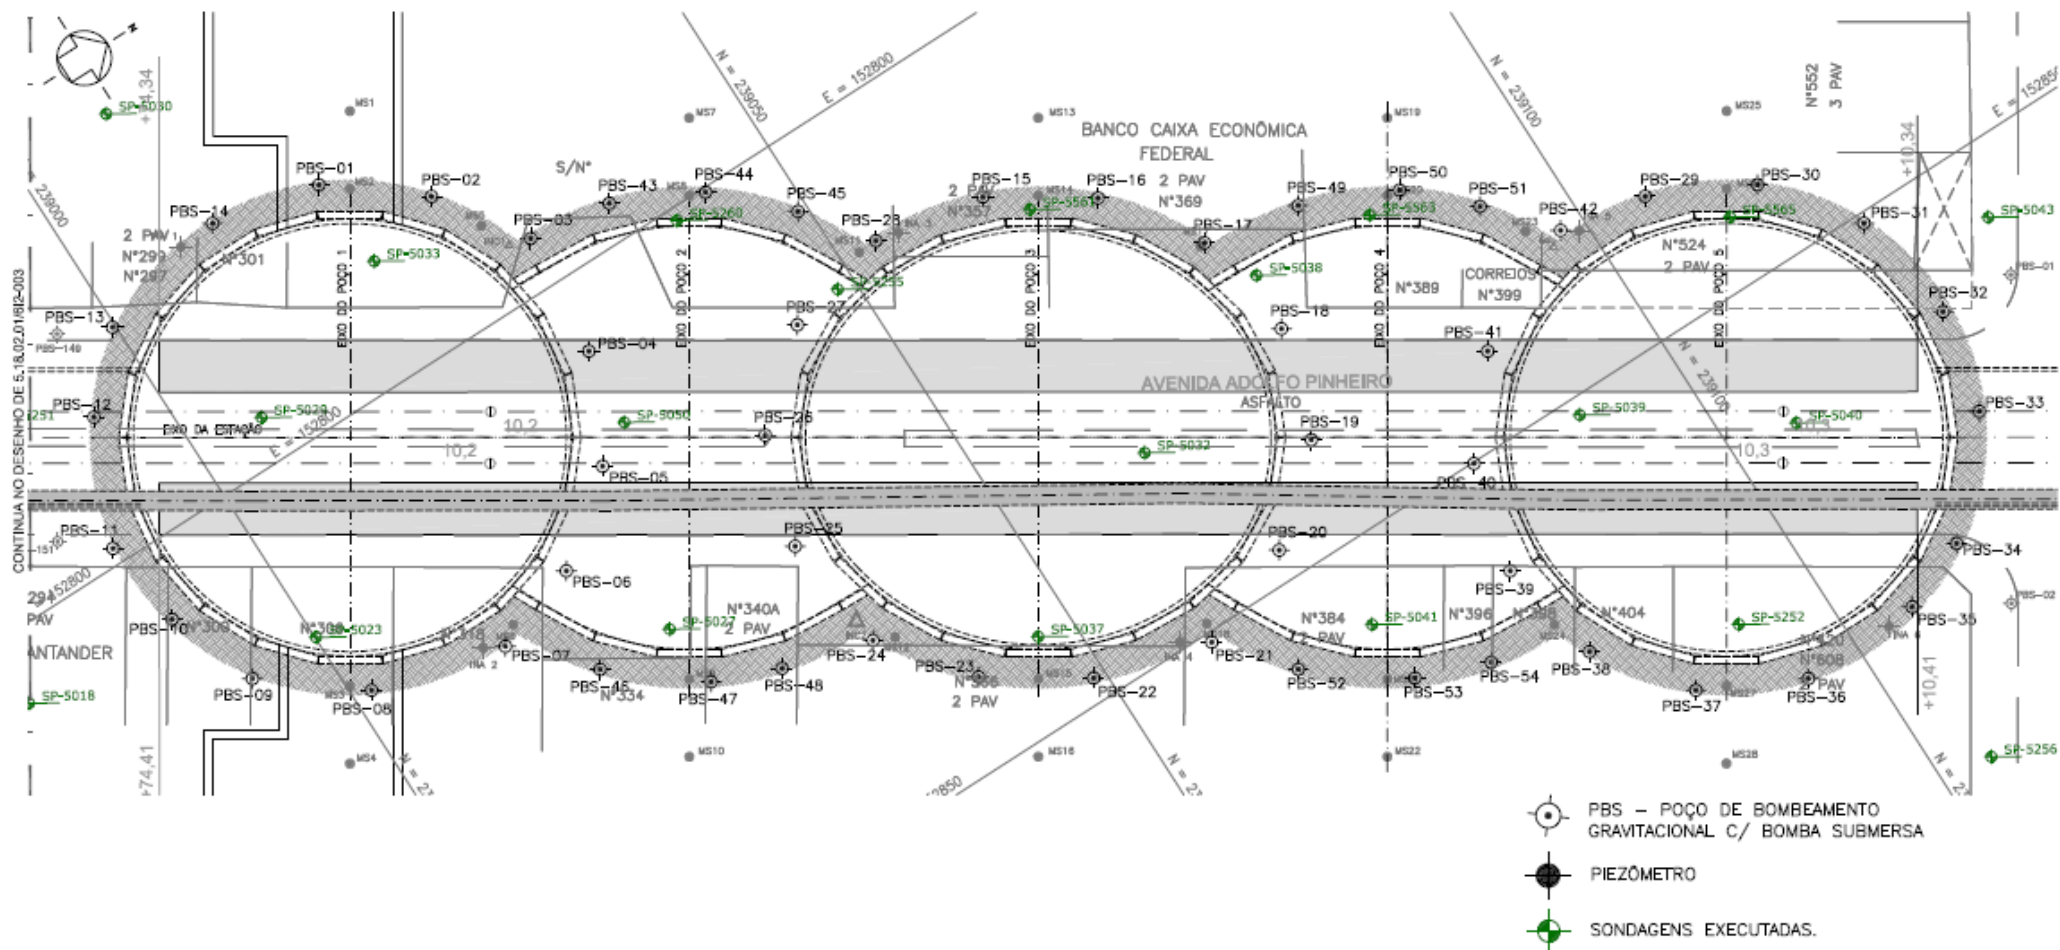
Planta do projeto de rebaixamento para a Estação Adolfo Pinheiro.
